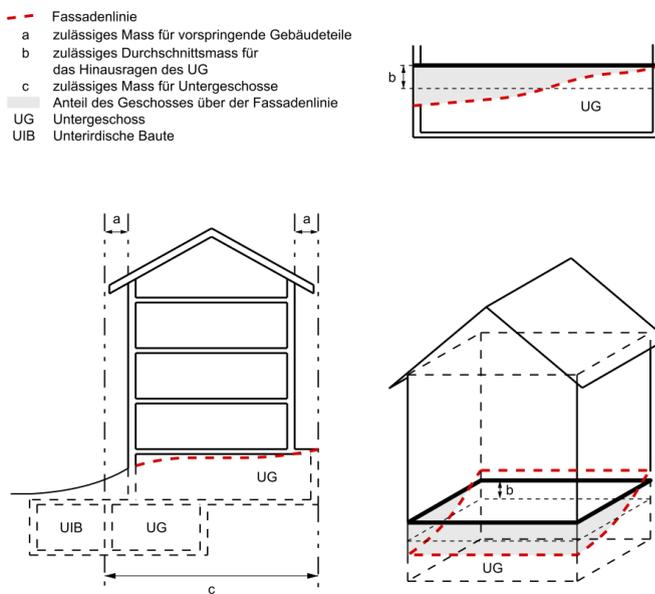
Figur 6.2 Untergeschoss, IVHB
